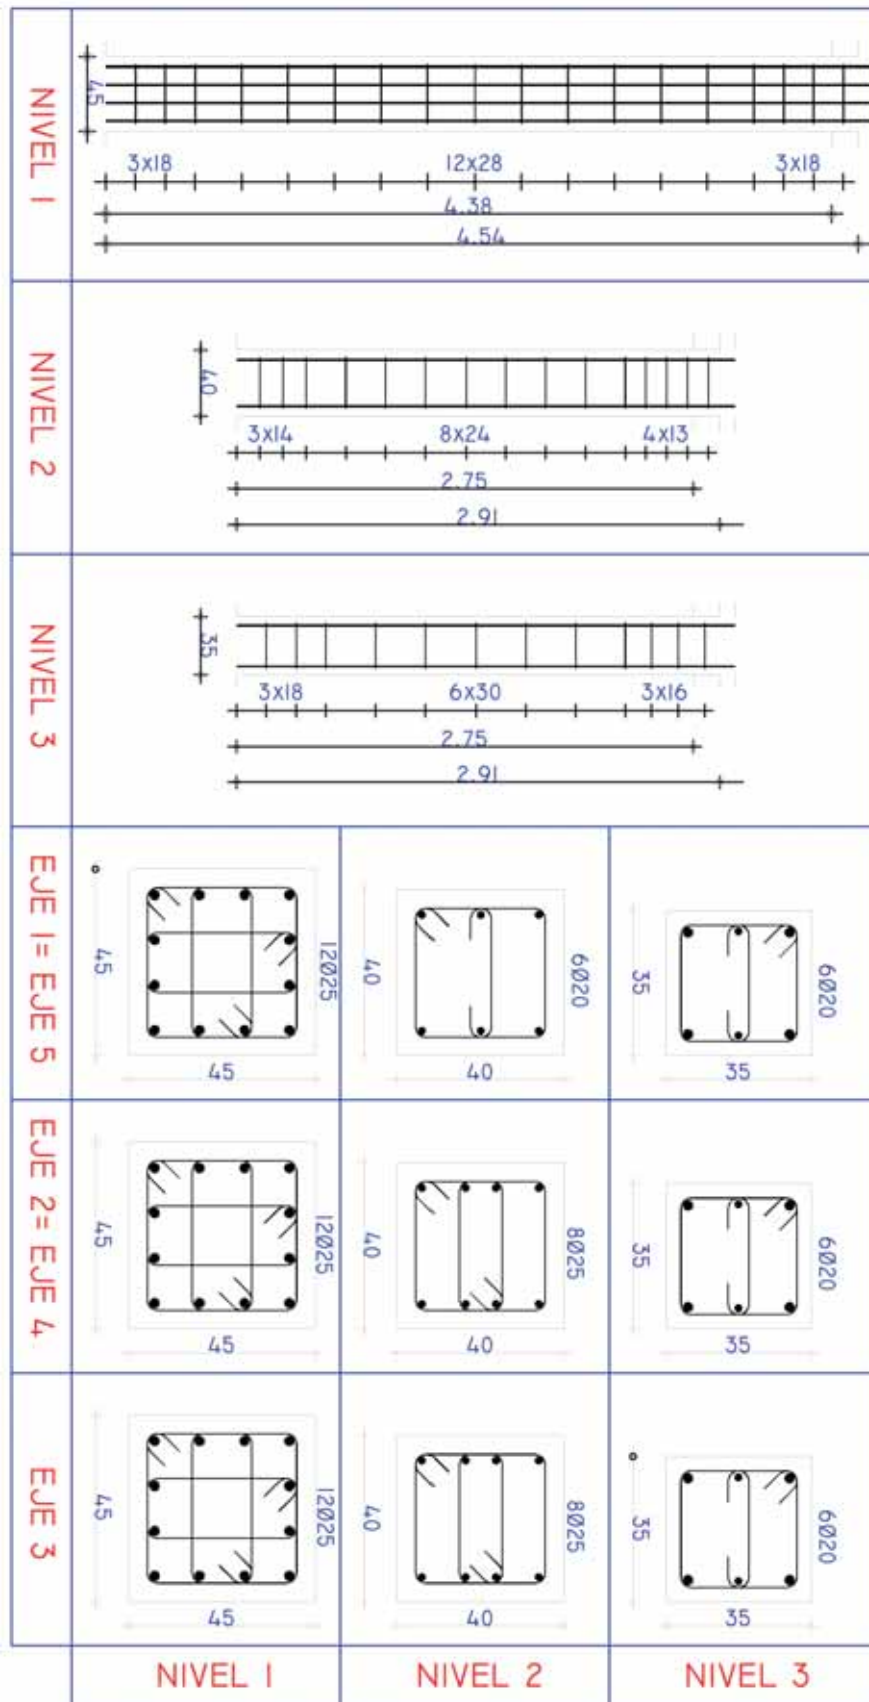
Detalles de armado de los pilares del pórtico exterior.
